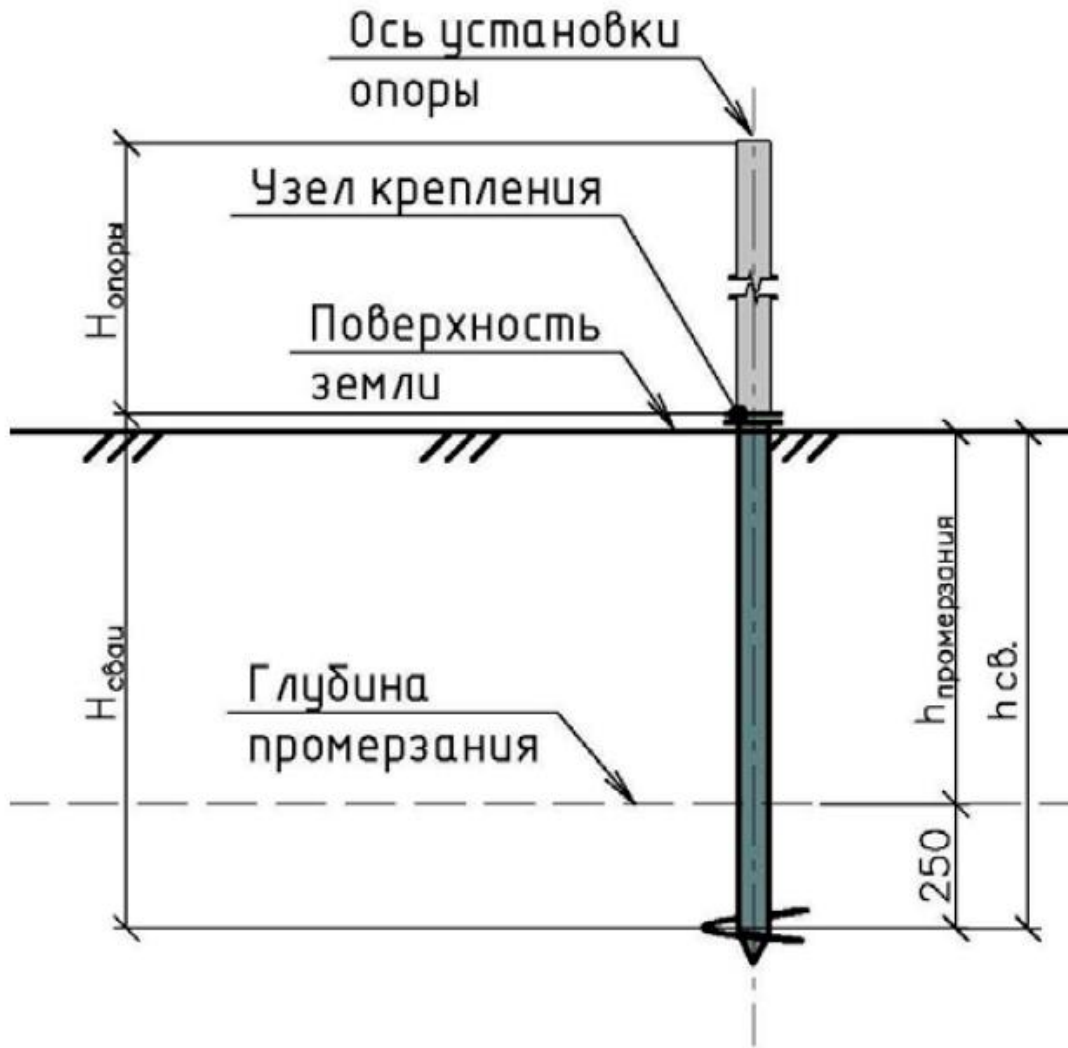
Схема устройства фундамента на винтовой свае
